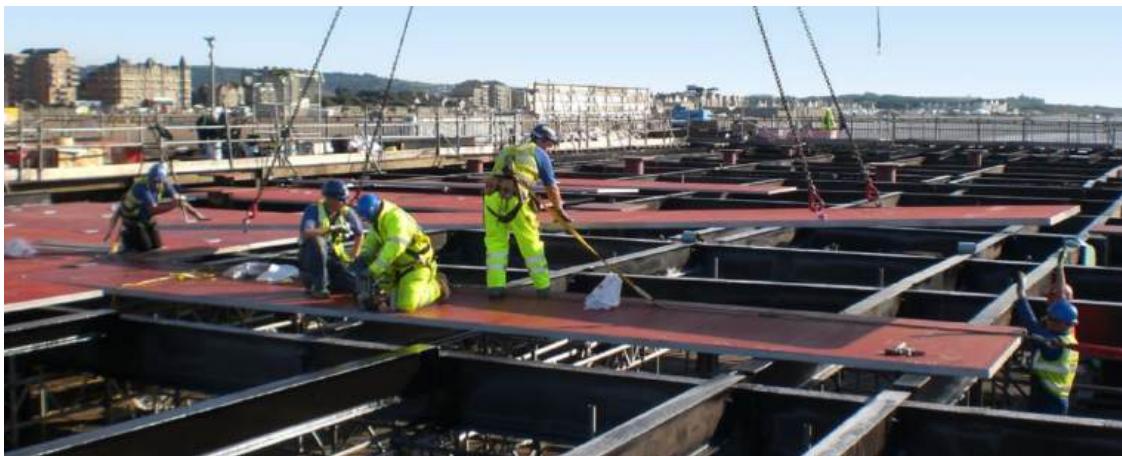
Système de plancher démontable Panneaux SPS – deux tôles d'acier avec noyau en polymère [37]
